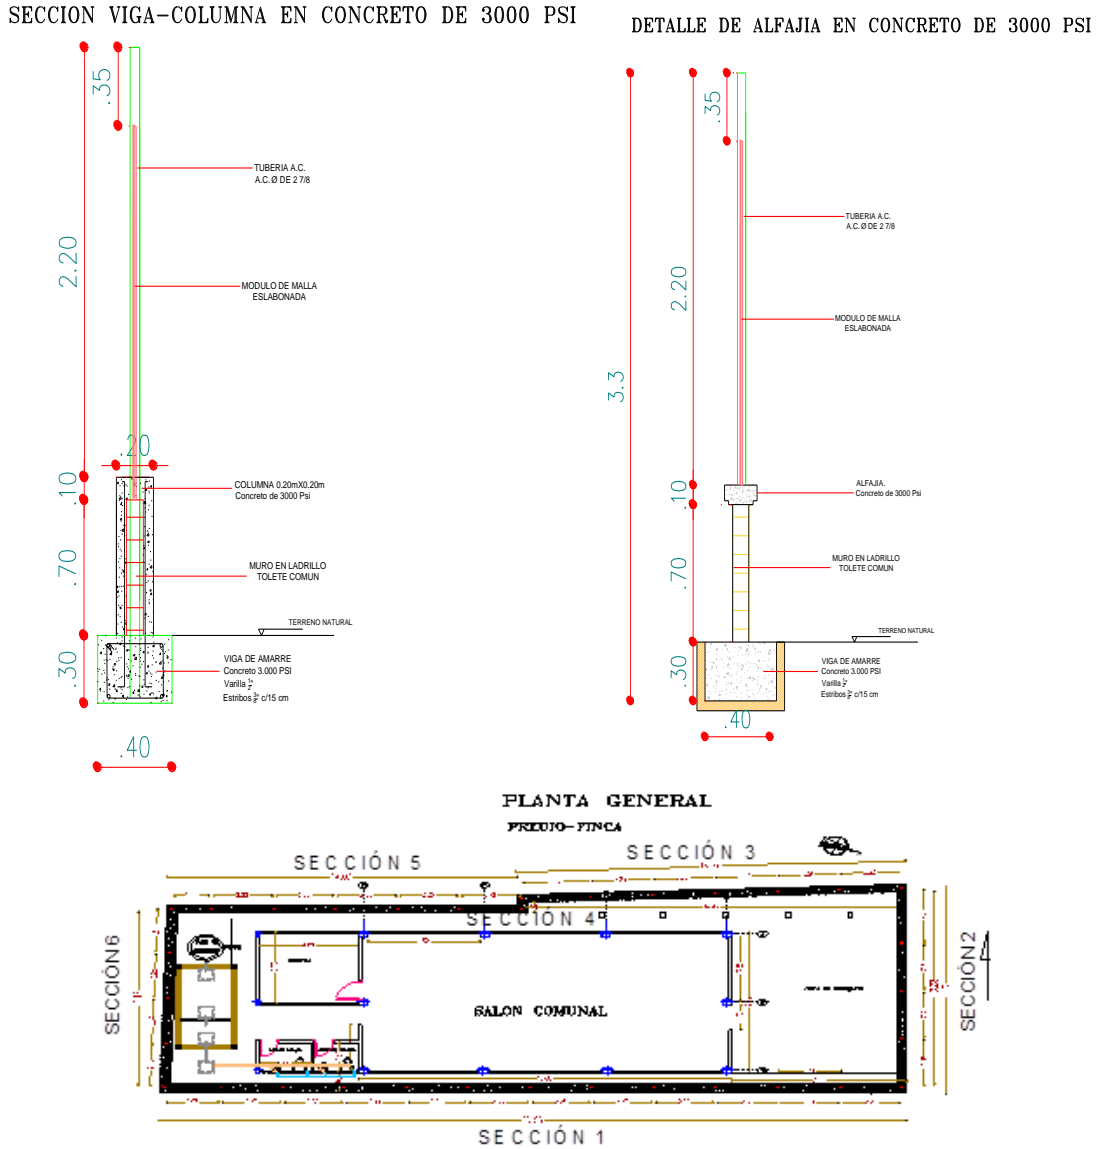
Detalle de viga de cemento, alfajía y columnas en concreto de 3000 psi. según planos del proyecto. Fuente: Unión Temporal MIDAS, 2016.
